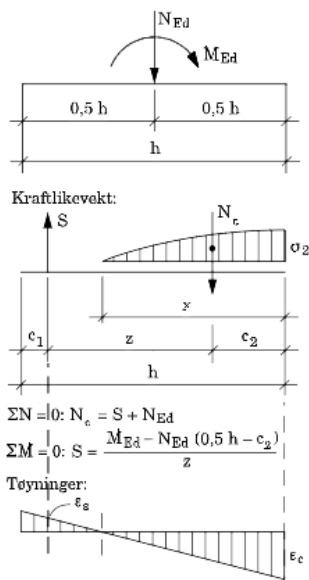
Spenningskontroll fra betongelementboken B.12 s.149
